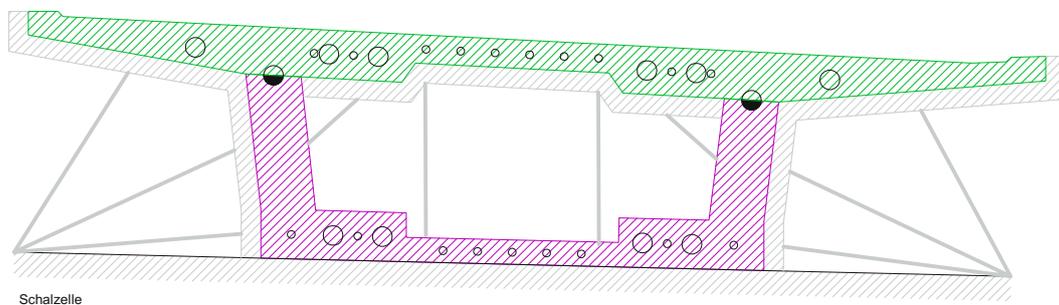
Schema der Betonageabschnitte in Ortbetonausführung (Eigene Darstellung in Anlehnung an den ASFINAG Bestandspläne Objekt B2314)
